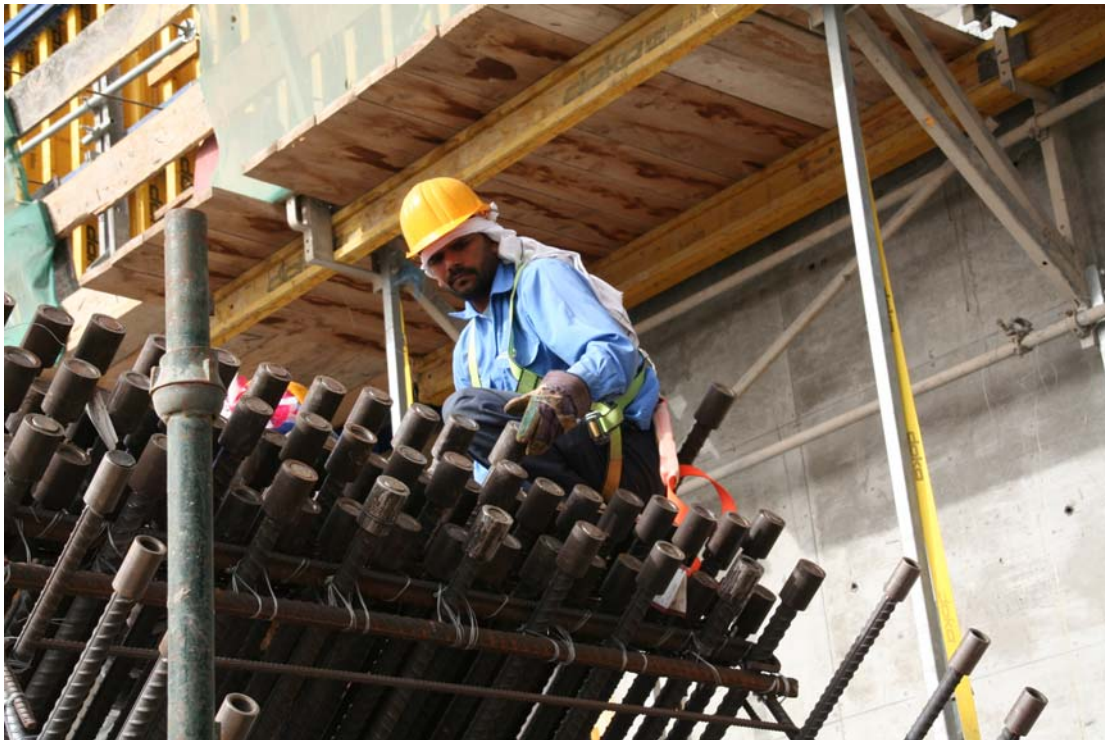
Bewehrungsstoß mit Schraubmuffen (Foto: Horst Werkle)
